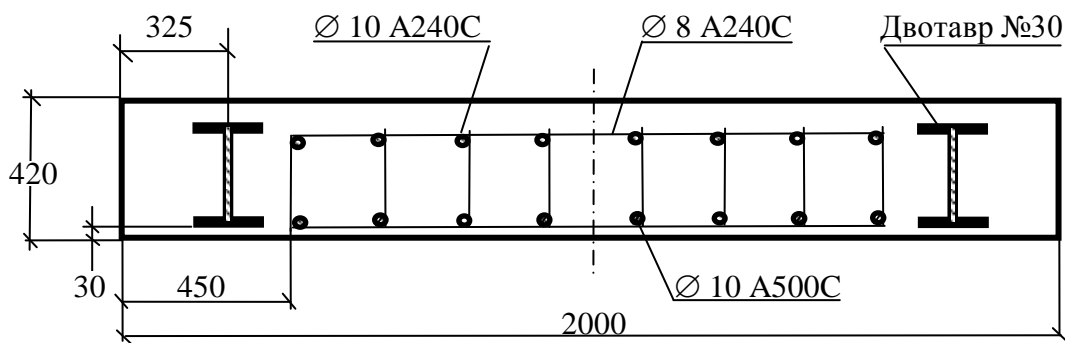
Схема перерізу сталезалізобетонної плити.
